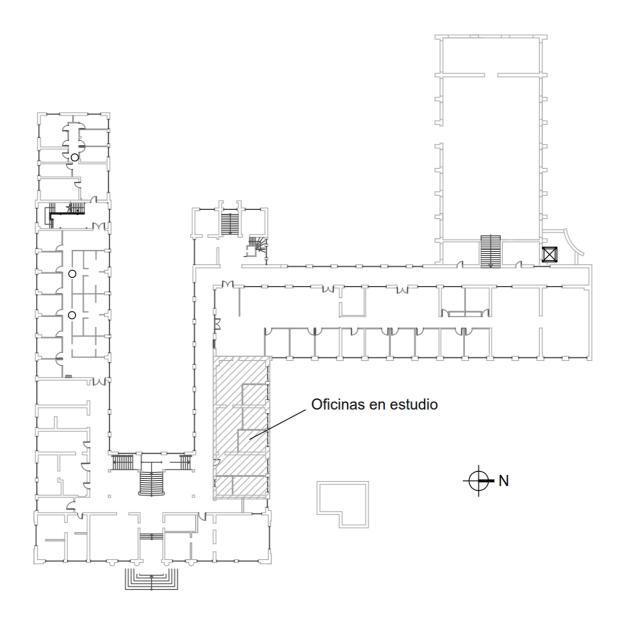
Planta primer piso Edificio IDIEM y zona en estudio
